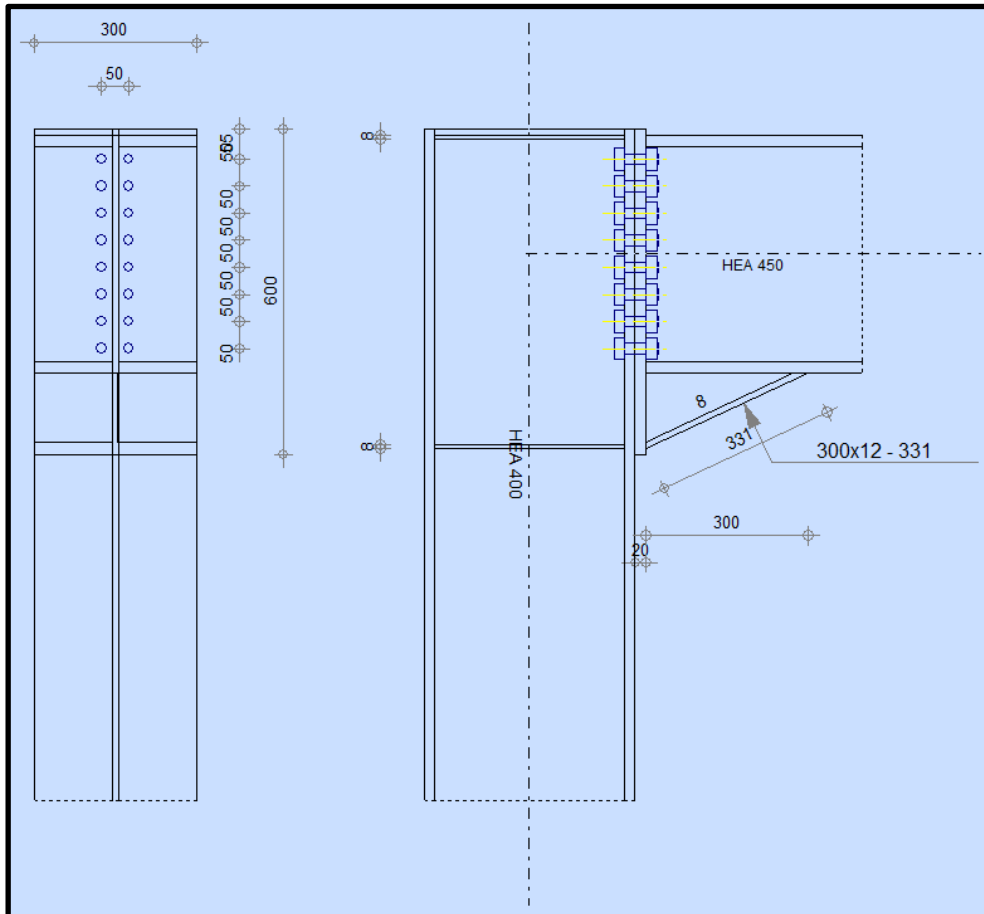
Schéma d'assemblage poteau HEA 400 – poutre HEA 450
